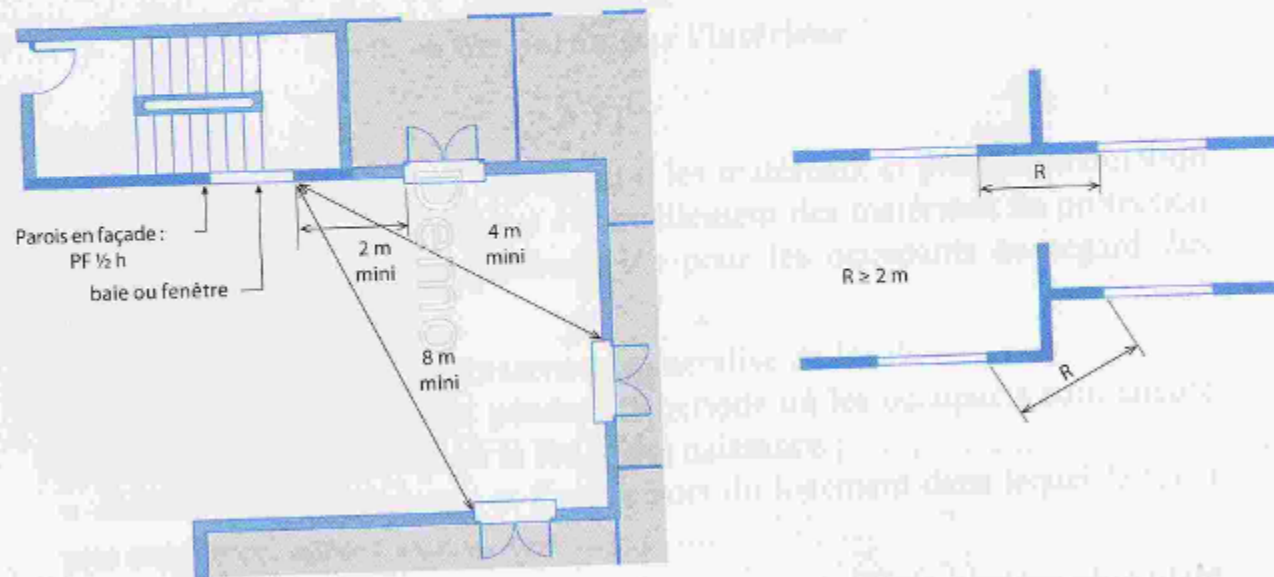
Distance minimale entre fenêtres pour les parois d'escaliers situées en façade.
